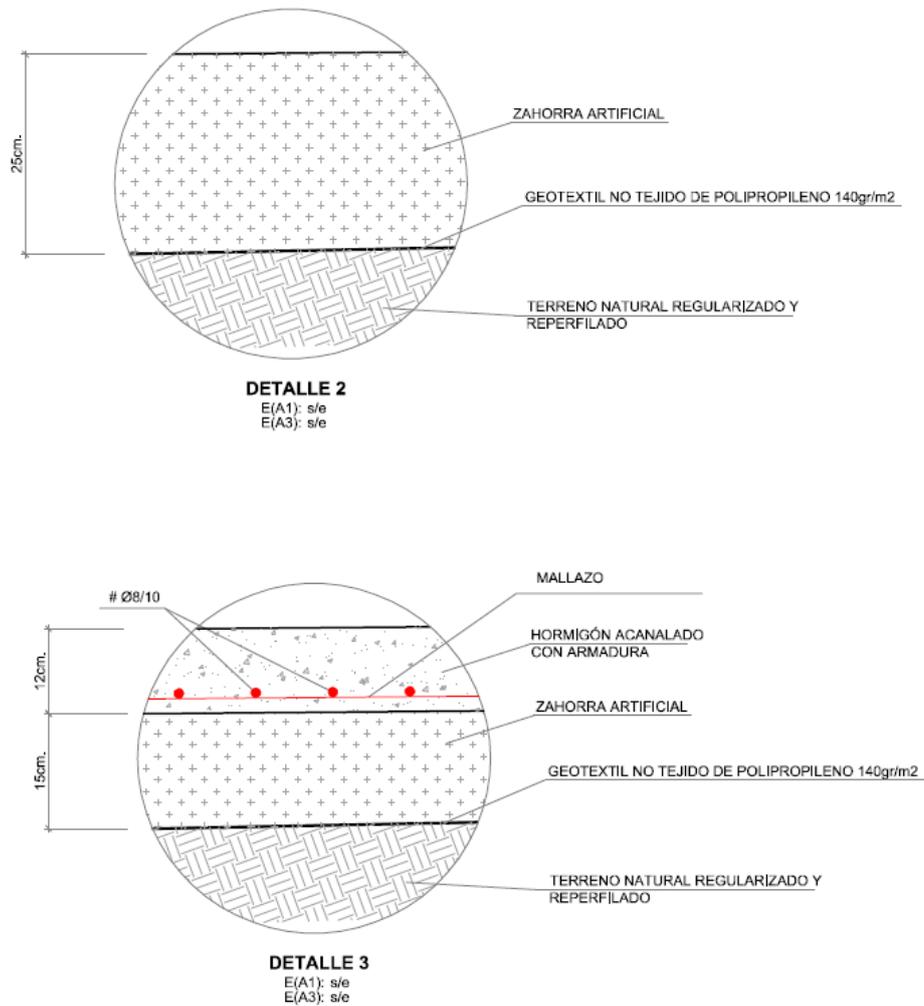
Secciones tipo 4 y detalle. Fuente: Desarrollo del Plan de Contingencia de abastecimiento en caso de rotura del Canal Bajo. caminos de acceso a las casetas 7 y8.
